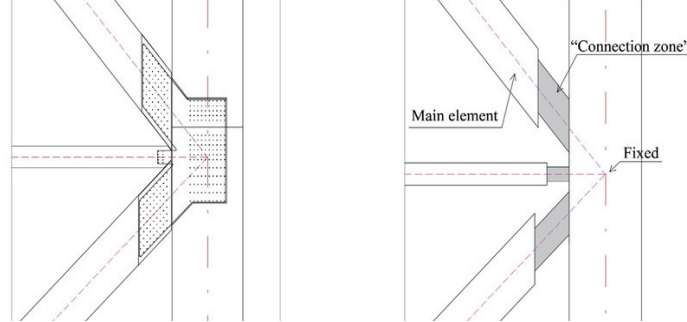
Detalle constructivo. Unión metálica entre elementos de la estructura.
